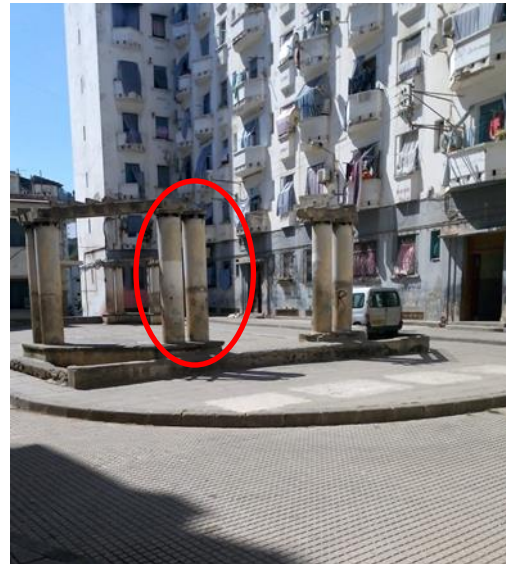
colonne- cheminée sur plancher de parking pour dégagement de fumée et aération
